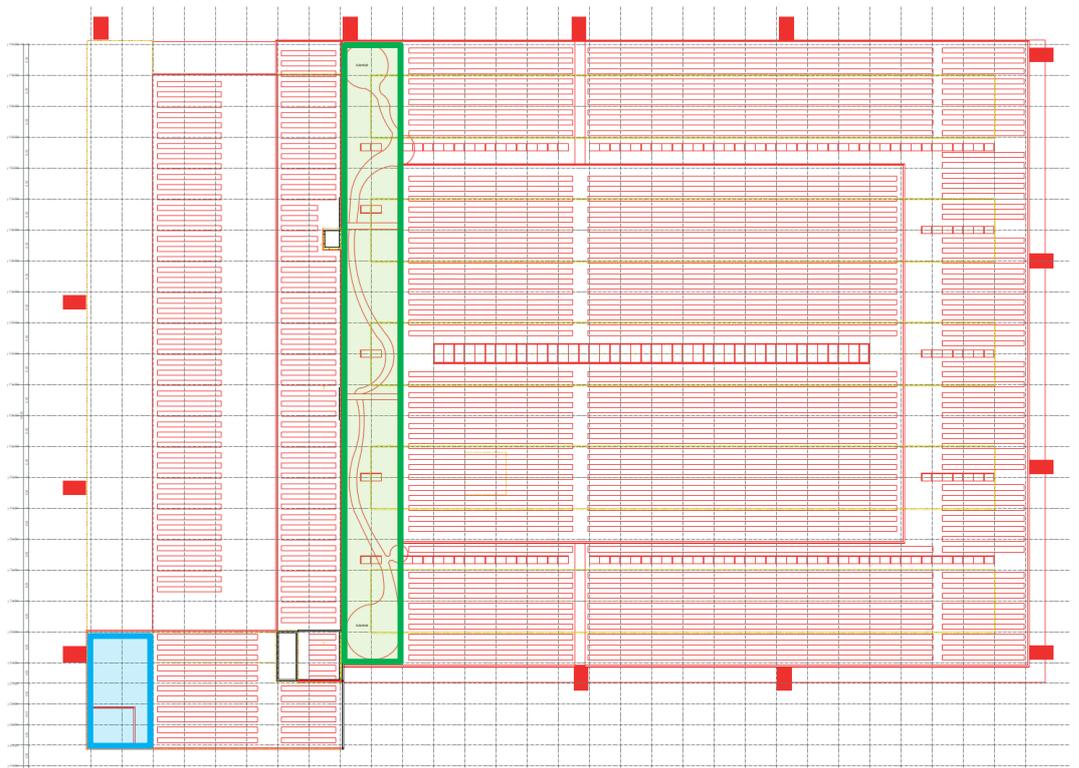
Dachaufsicht des PZ. Blau: Lage Dachterrasse, Grün: Lage Dachgarten (Richtprojekt PZH, ANS Architekten)
